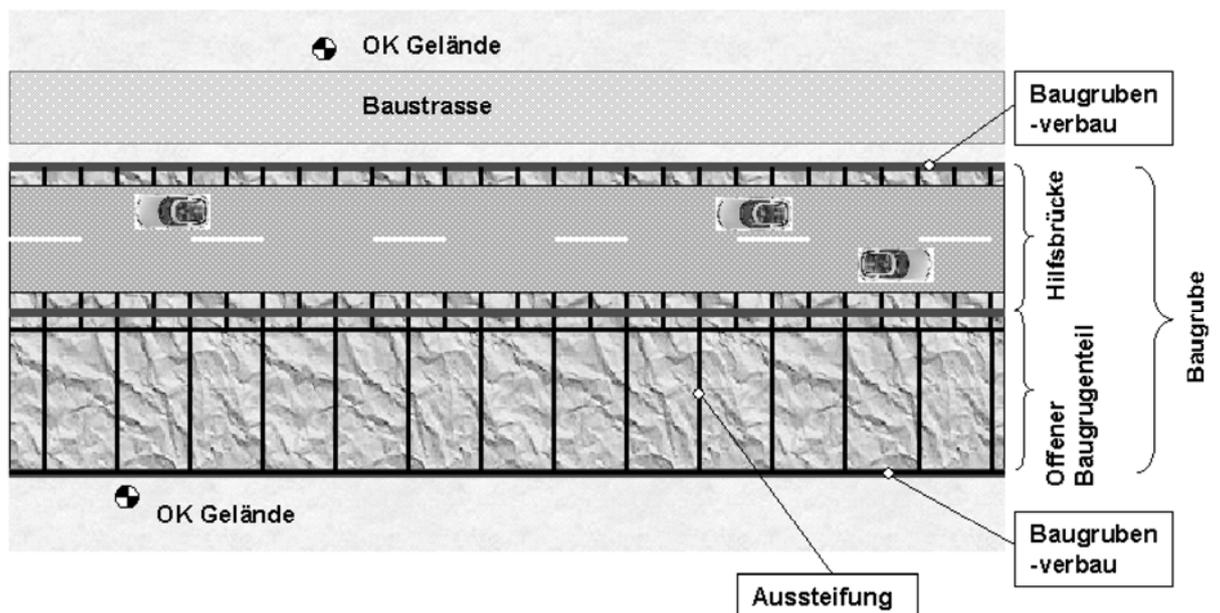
Draufsicht auf eine Linienbaugrube in offener Bauweise mit einseitiger Hilfsbrücke
